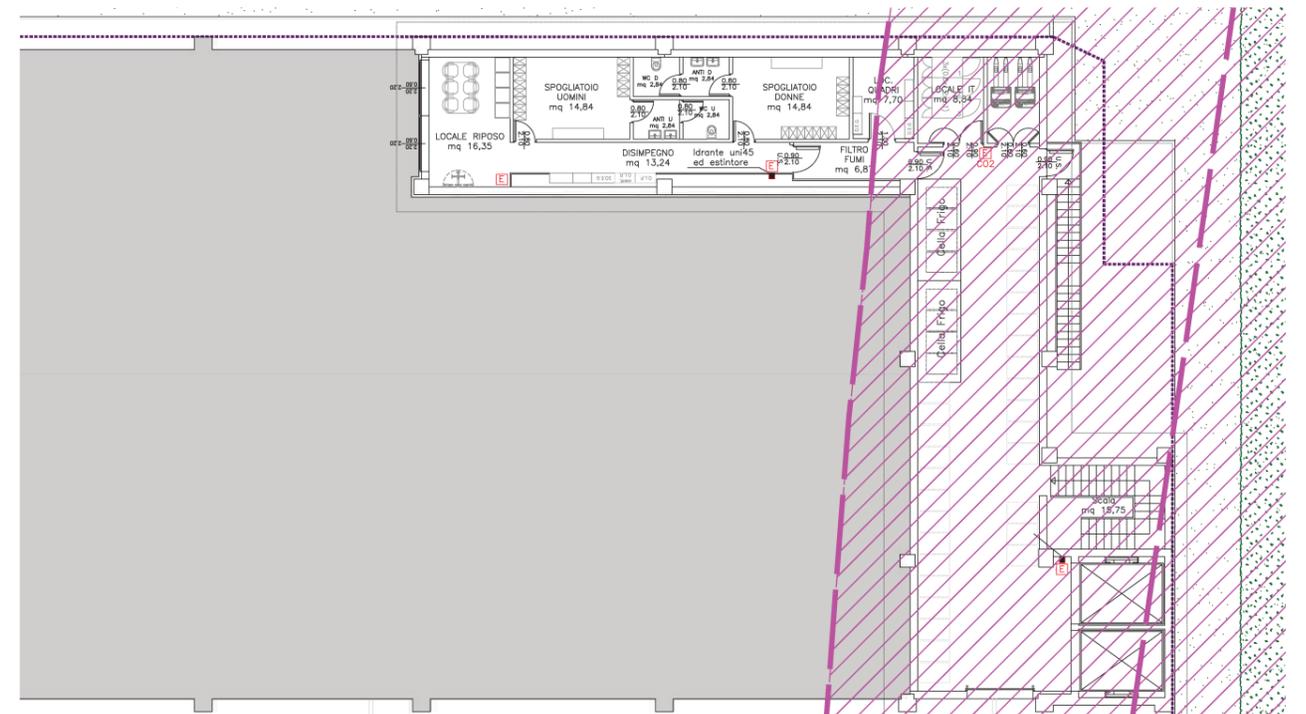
Focus Piano Primo con individuazione della fascia di rispetto dell'elettrodotto
